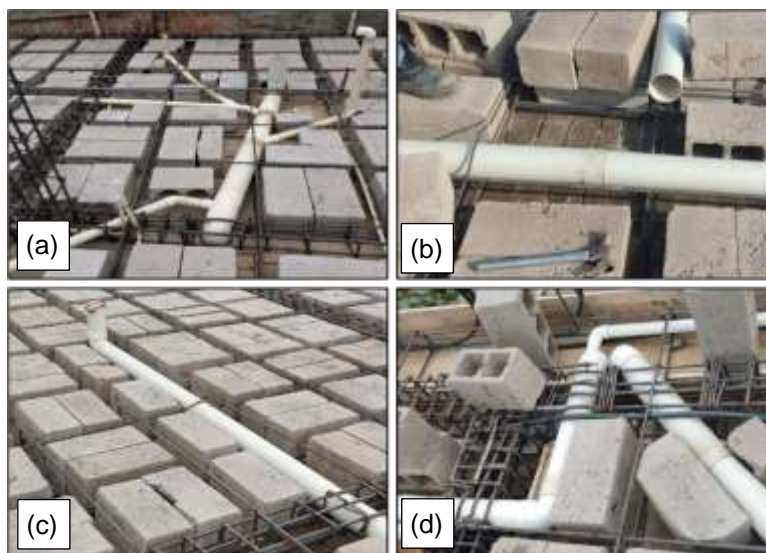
(a) Ducto ubicado erróneamente. (b) y (c) Tubería que invade la sección de una viga. (d) Barras ya esforzadas debido a la colocación de bajante.
